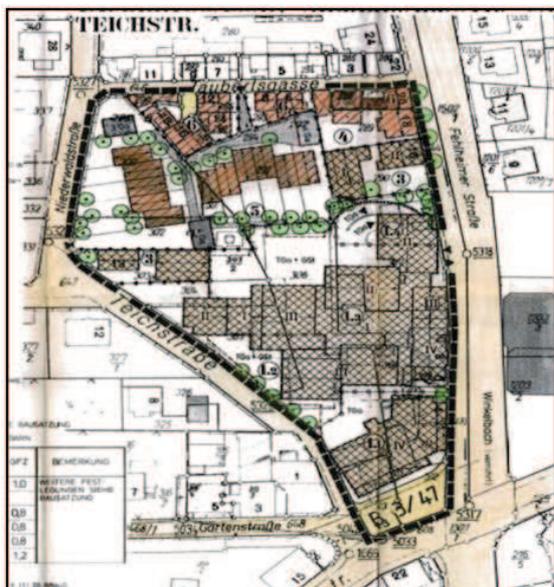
(links) Auszug aus dem Bebauungsplan BO 33 2. Änderung
